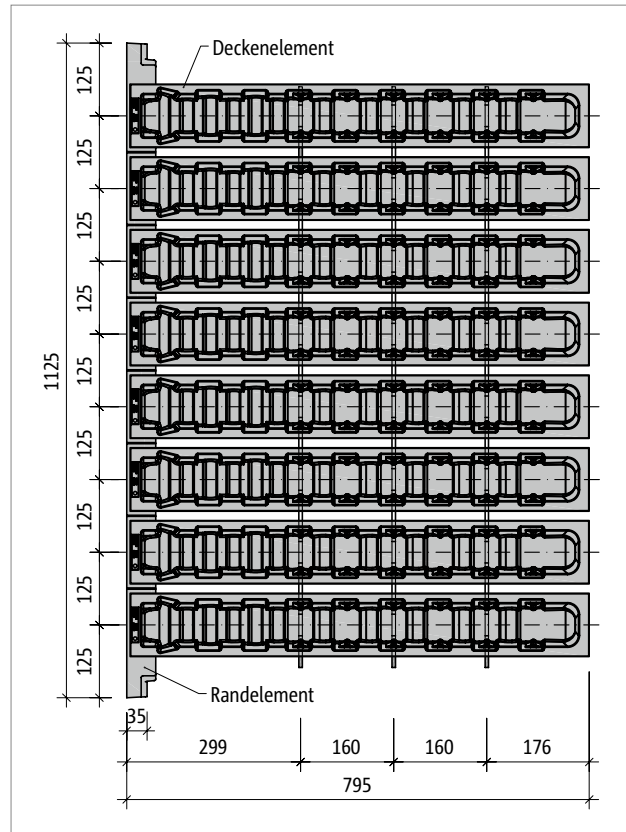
Schöck IDock®: Produktgrundriss IDock2
